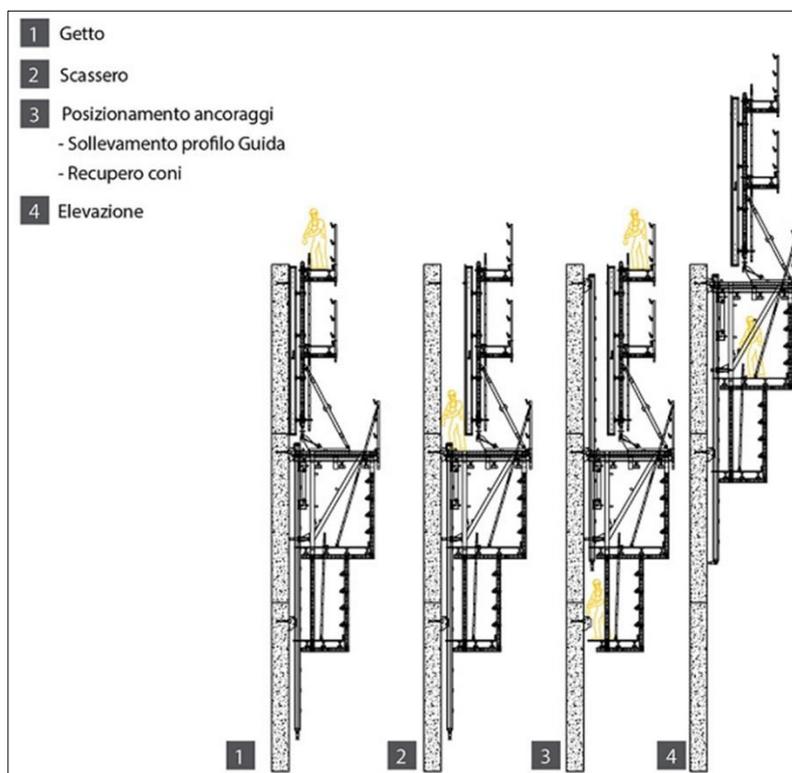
schema tipologico di montaggio delle casseforme rampanti
